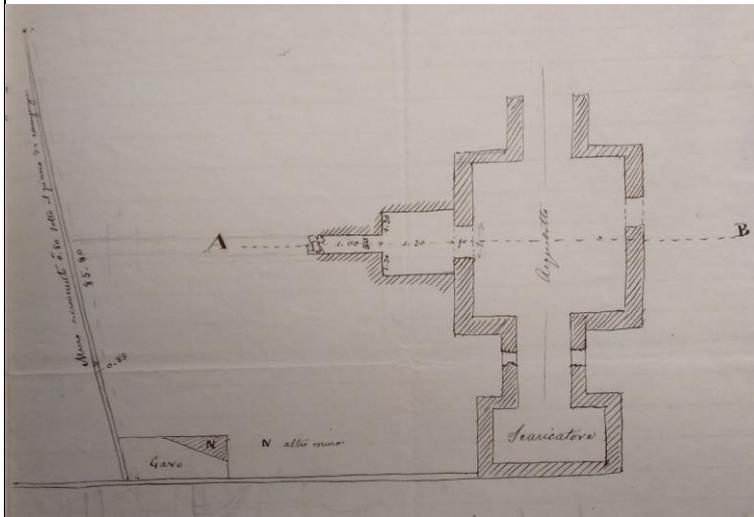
Pianta e sezione dell'acquedotto nei pressi dello scaricatore.
